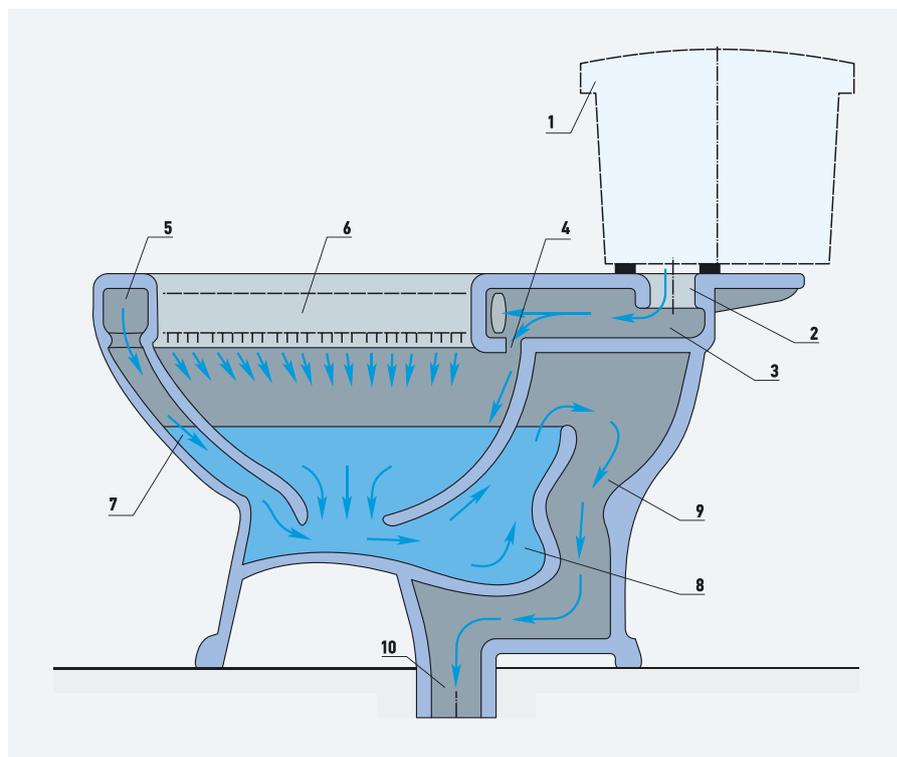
Схема усовершенствованного сифонирующего унитаза (1 — смывной бачок; 2 — входной патрубок; 3 — приемная полость; 4 — щель для омывания тыльной части чаши унитаза; 5 — канал под отбортовкой; 6 — отбортовка чаши унитаза; 7 — канал для подпитки эжектора и сифона; 8 — предсифонная полость; 9 — сифонная часть выпускного канала; 10 — выпускной патрубок)
